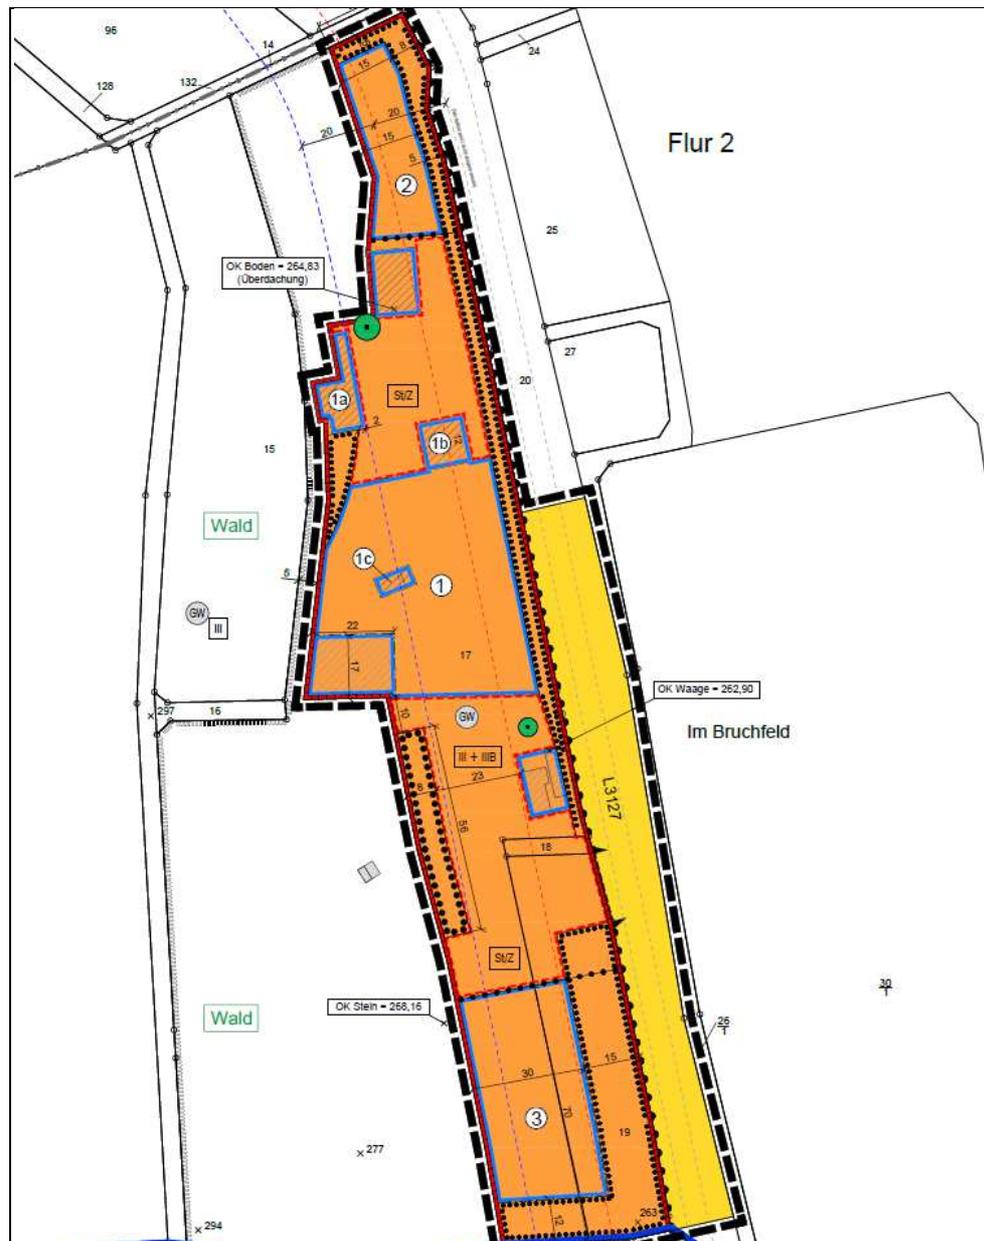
Bebauungsplanentwurf Auf dem Streich / Im Bruchfeld.
